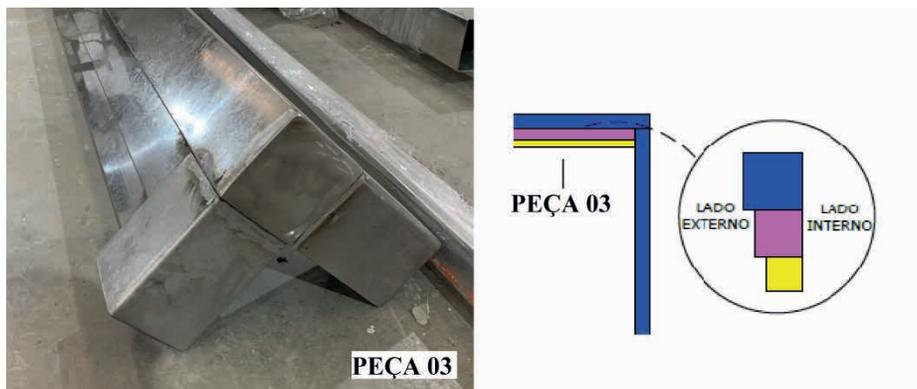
Detalhe da viga superior com dois tubos soldados na sua base e perfis “U” na extremidade para encaixe entre vigas e viga-pilar
